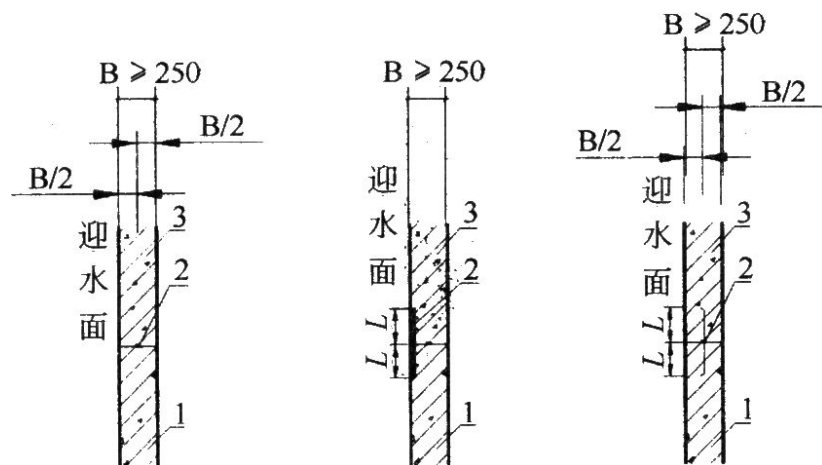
4. 6. 2-3 防水混凝土结构施工缝形式构造
